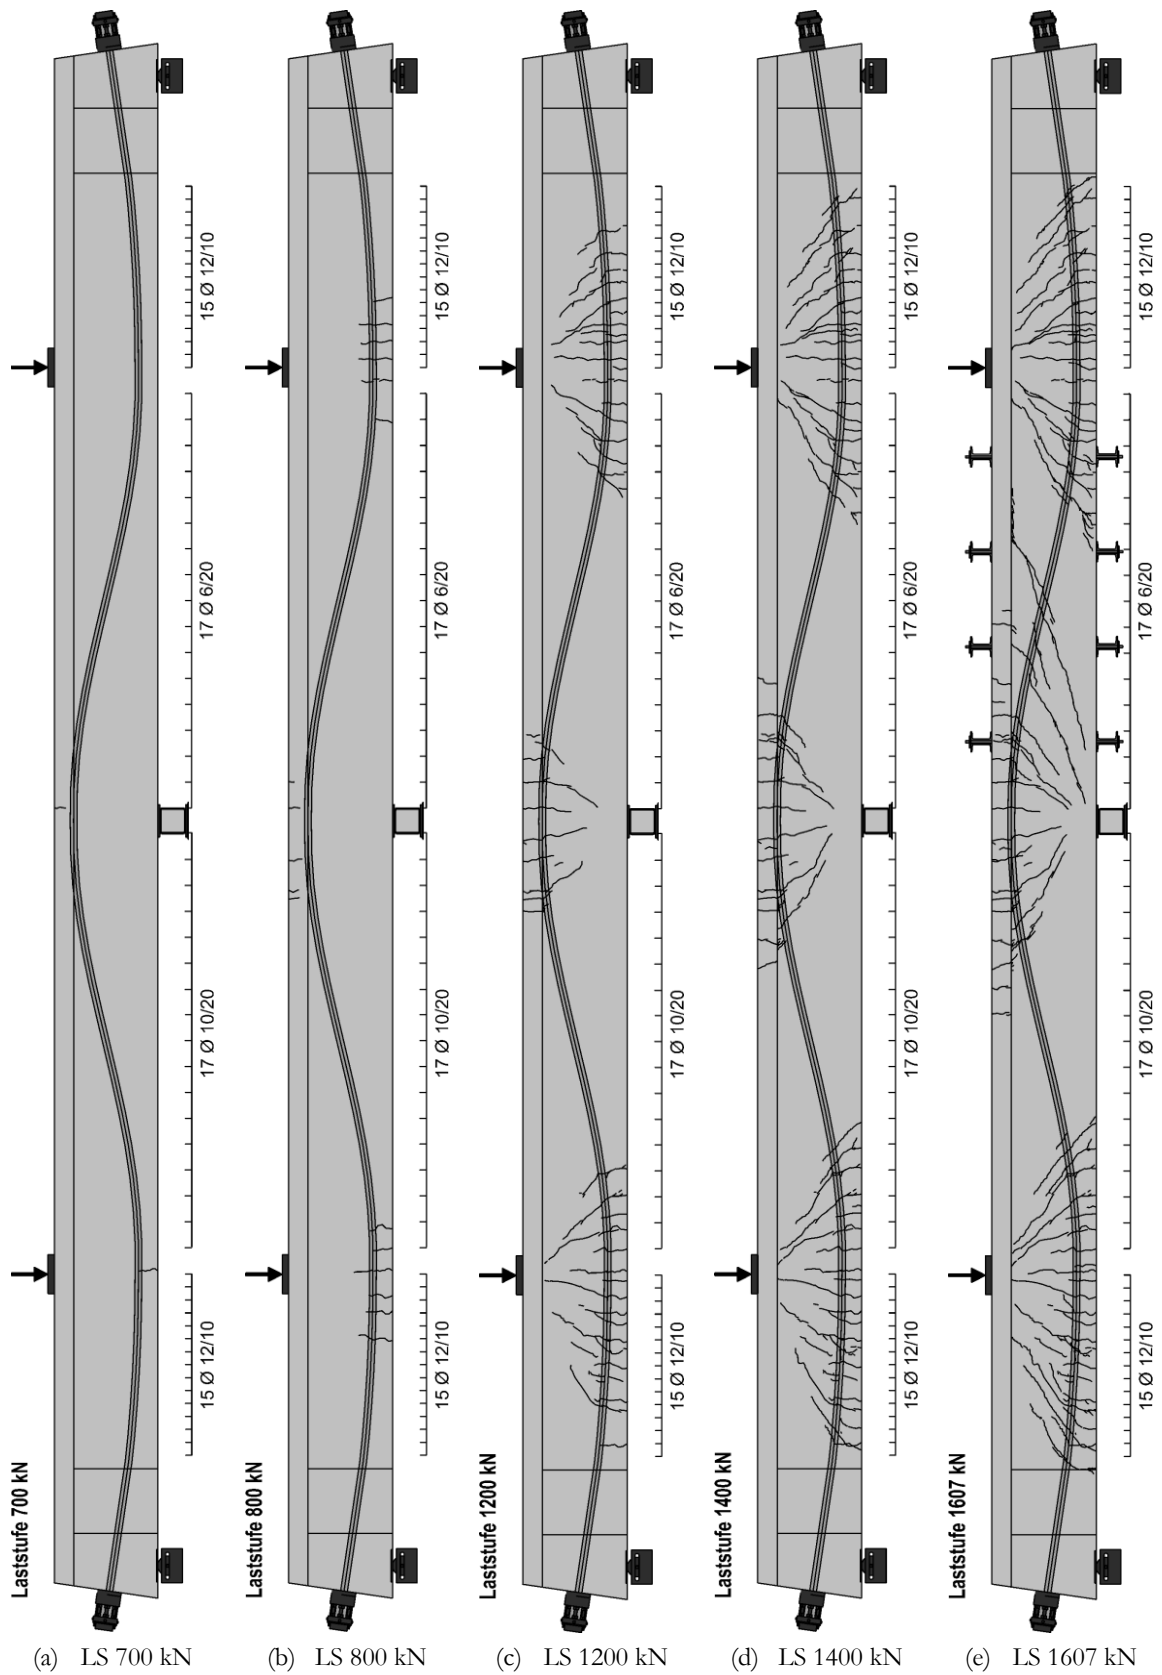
Rissbilder des Versuchsträgers DLT 2 für ausgewählte Laststufen, Teil 1
